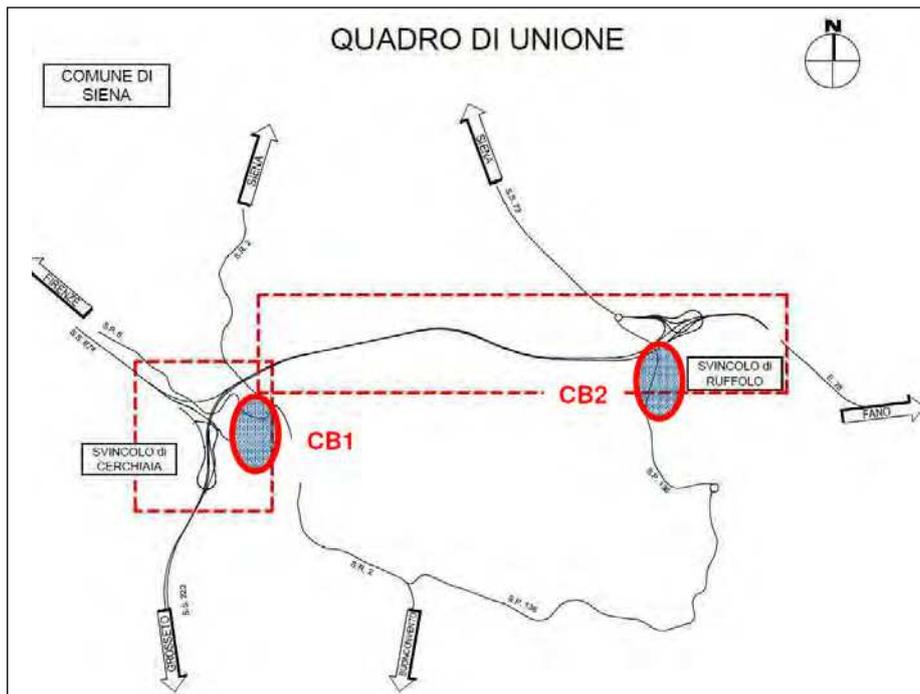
Localizzazione delle aree di cantiere.
